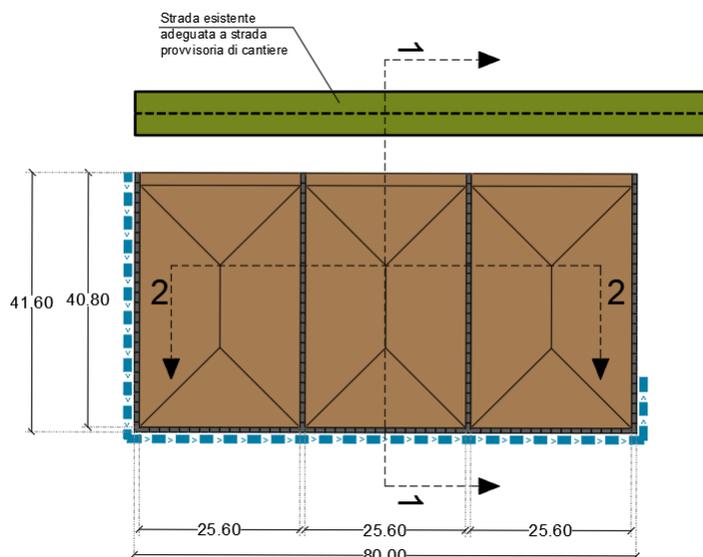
Planimetria depositi DI05 - DI06 - DI09
